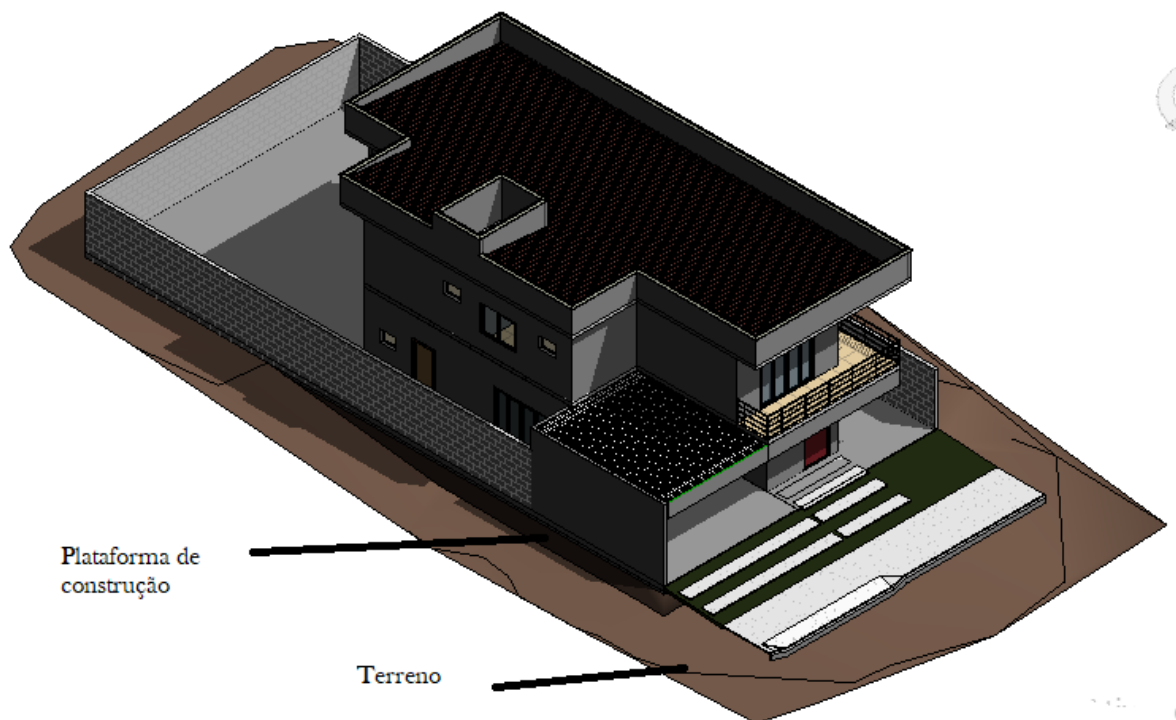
Aba Massa e Terreno Plataforma de Construção
